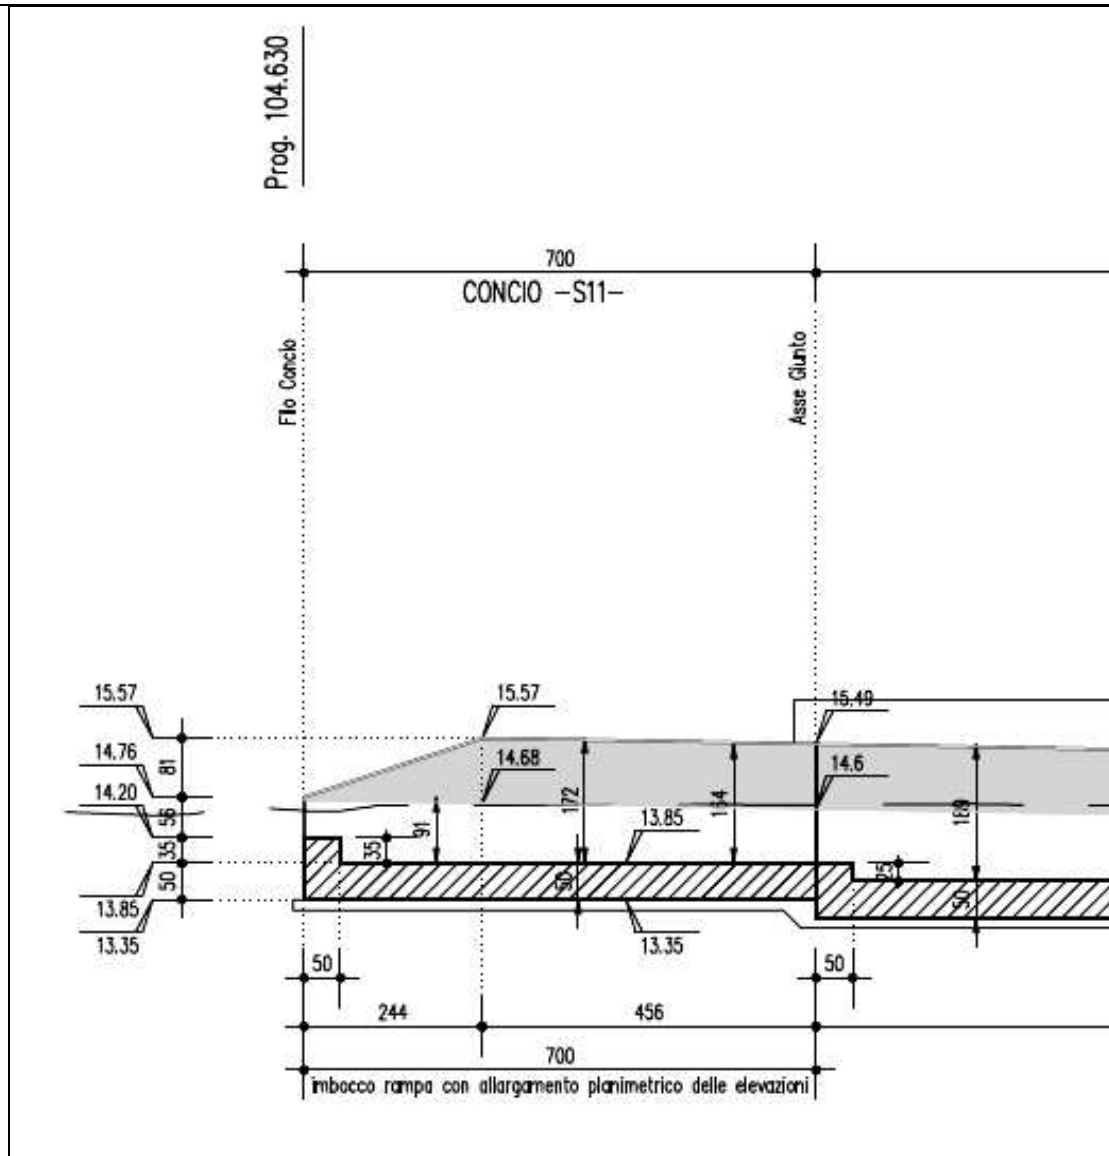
PARTICOLARE CONCIO SUD DI ESTREMITÀ
